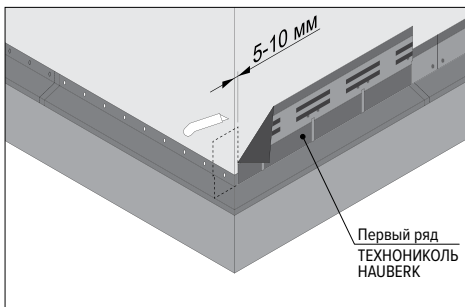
Монтаж второго и последующих рядов фасадной плитки
